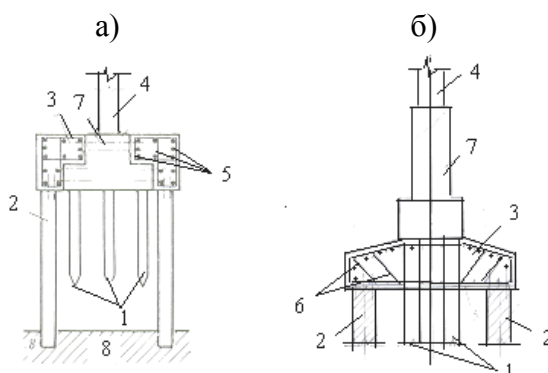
Усиление фундамента ростверком, расположенным в пределах высоты фундамента (а) и под подошвой фундамента (б):
